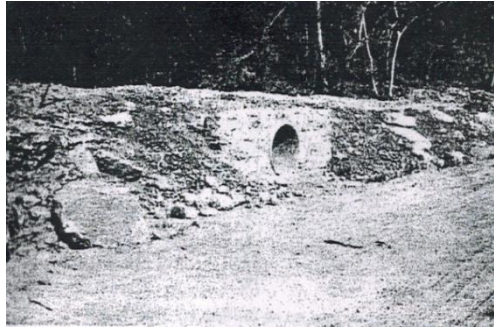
Alcantarilla de tubo en un camino de construcción.
